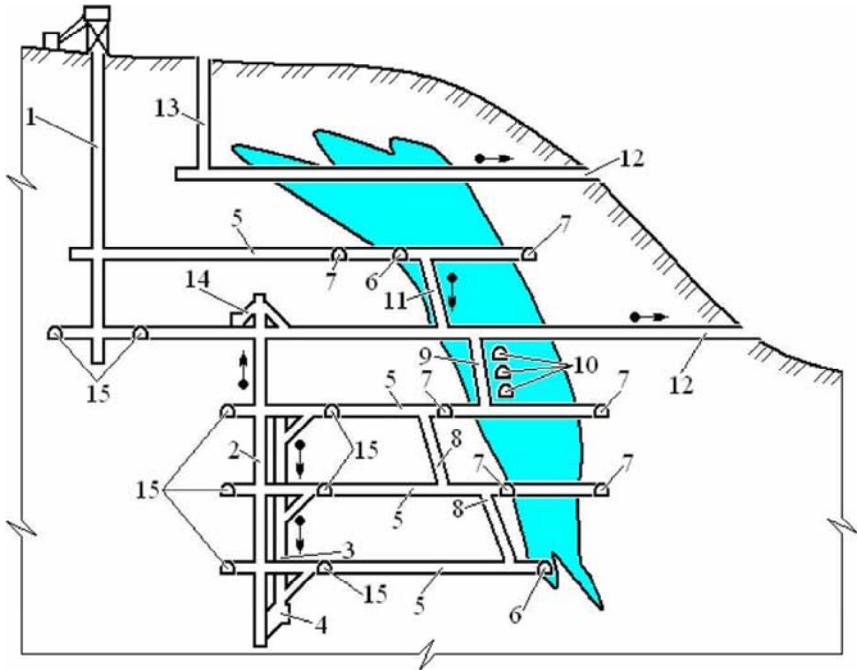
Схема расположения подземных горных выработок при разработке рудной залежи (разрез вкрест простирания)
